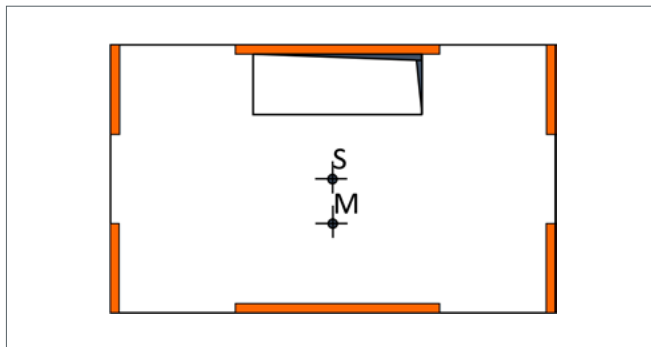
Grundriss mit Öffnung in der Nähe von Schubwänden
